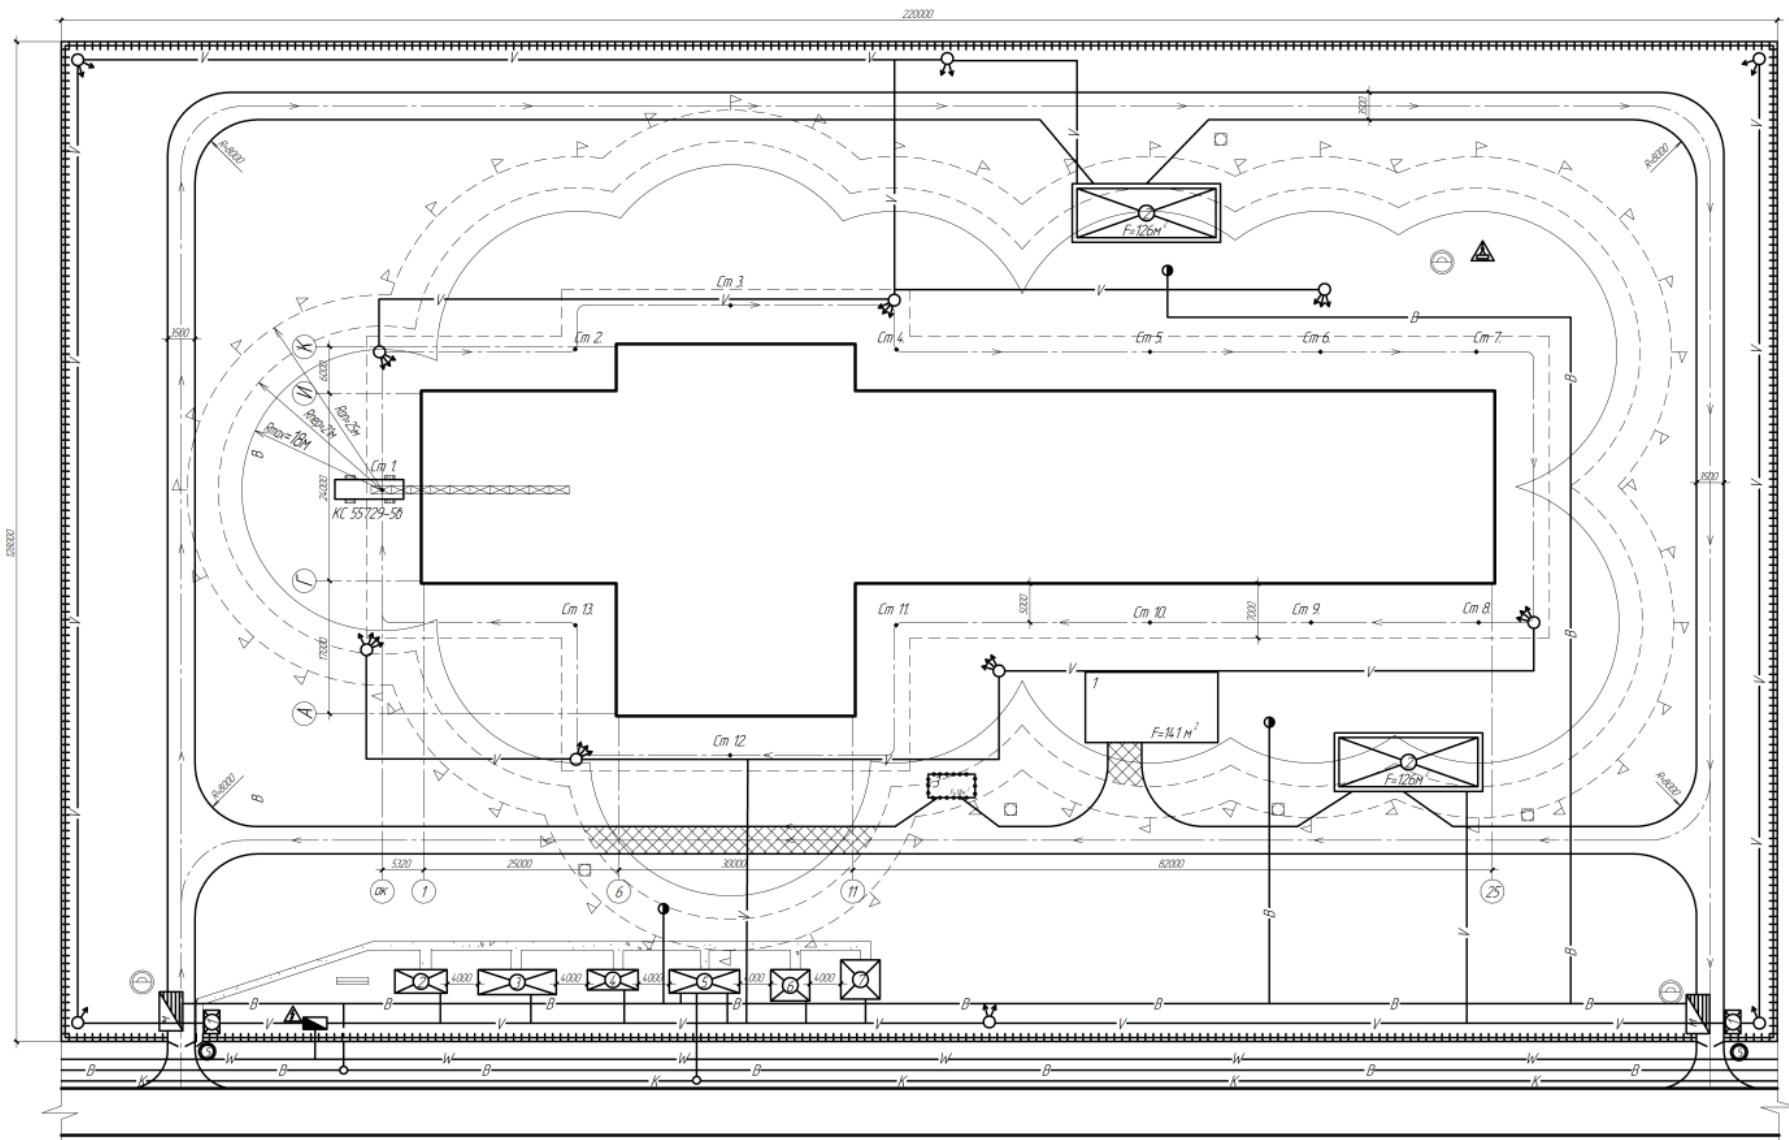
Строительный генеральный план строительной площадки ООО «Гарант Строй»
